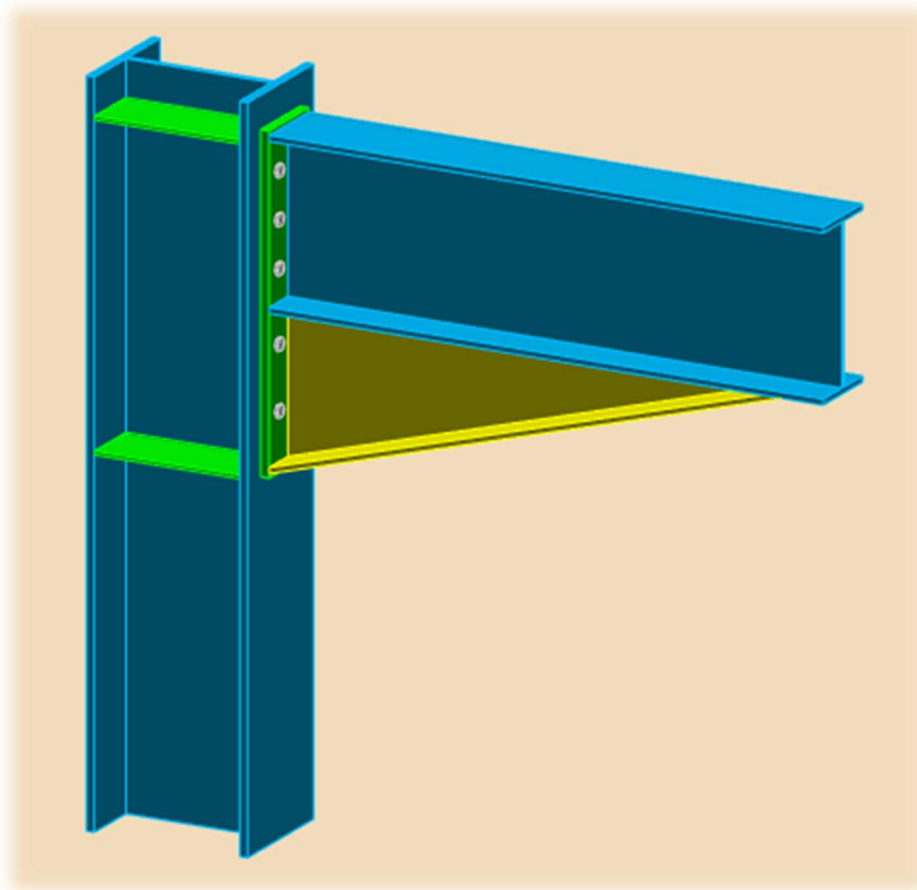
3D d'assemblage poteau - poutre (HEA400-IPE400)
